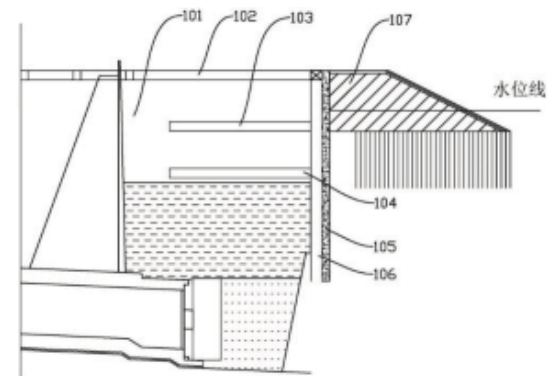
河岸围堰结构拆除施工方法拆除第三道支撑时往基坑内灌水的示意图
